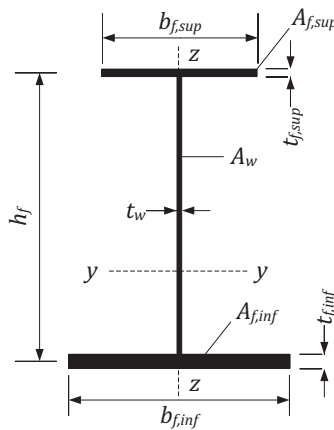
Notations pour la poutre maitresse (échelle verticale déformée).
